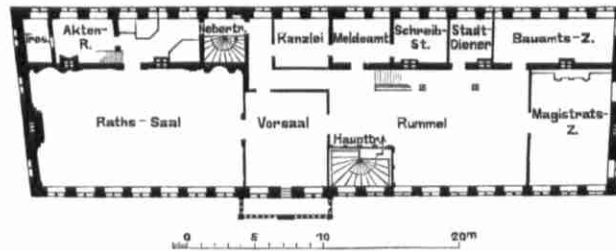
Jetziger Grundriß des Hauptgeschosses.
